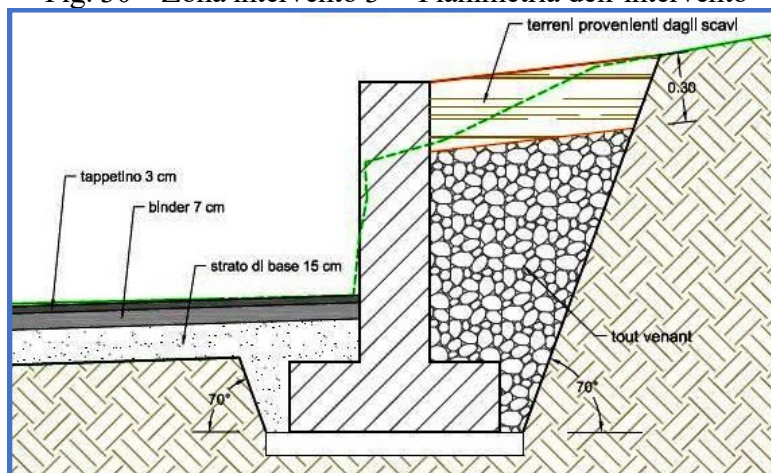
Zona intervento 3 – Sezione tipo del muro in c.a.
